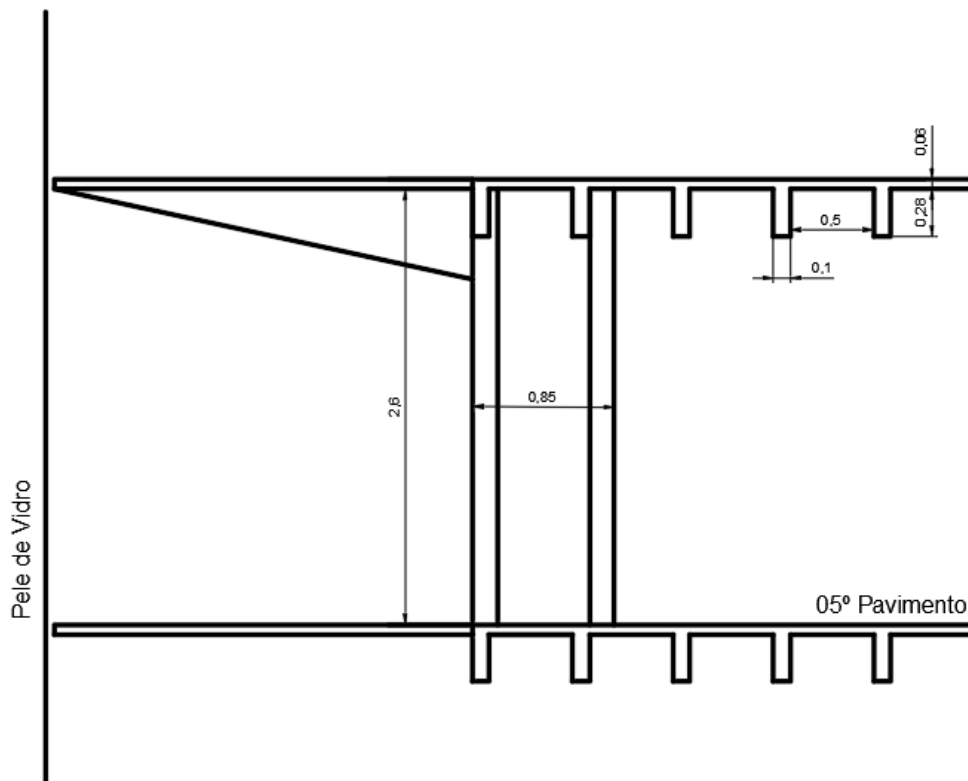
Corte da laje-grelha (Fonte: FAU-USP)
